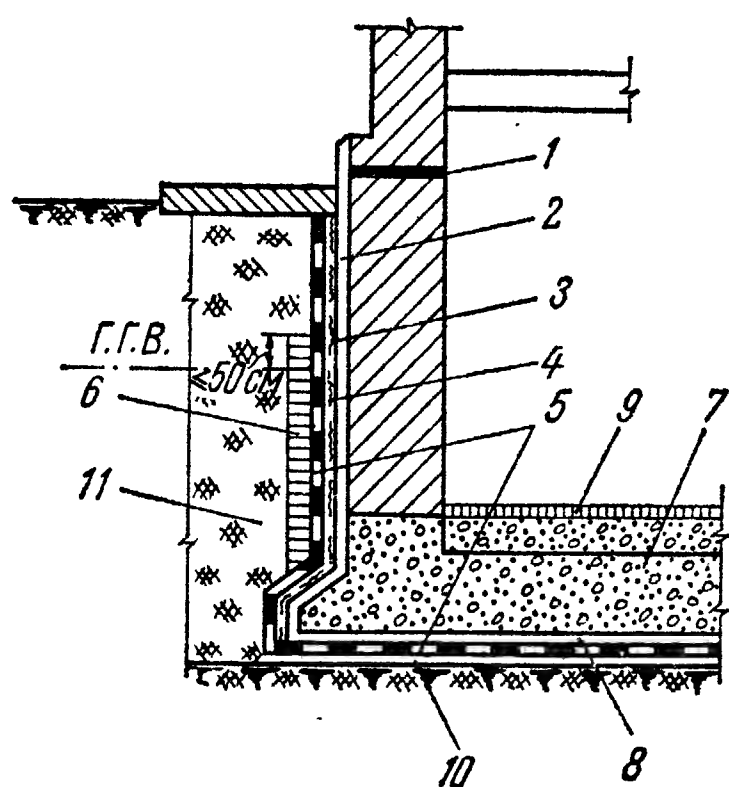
Оклеечная гидроизоляция с глиняным замком:
